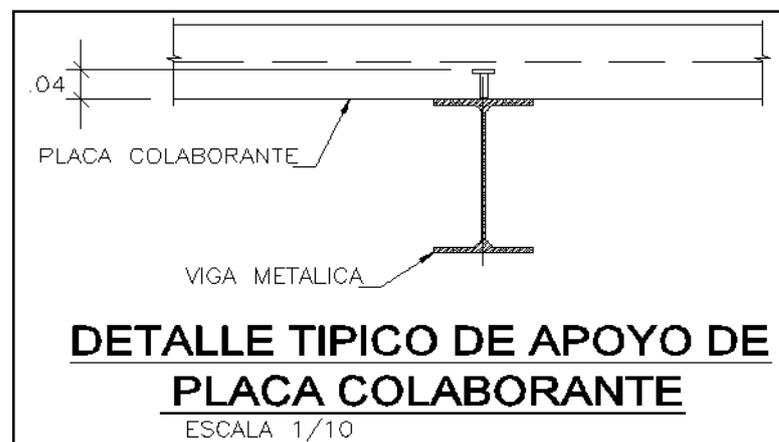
Detalle de apoyo. FUENTE: Elaboración Propia
